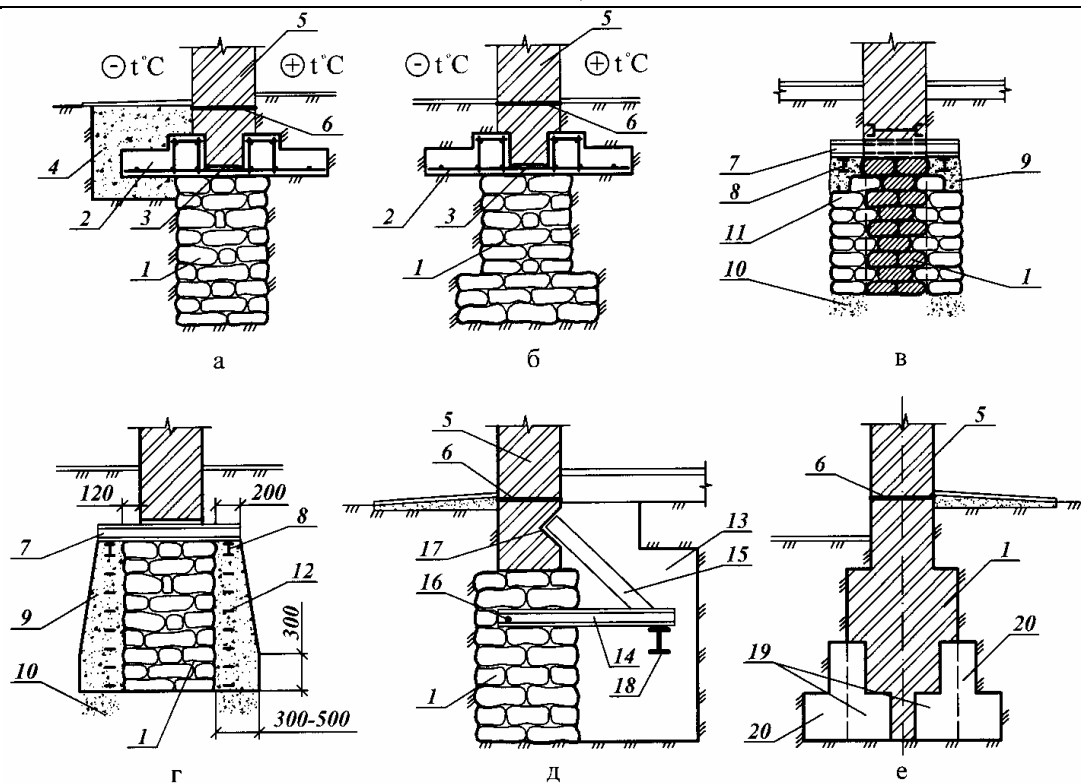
Усиление фундаментов увеличением их опорной площади:
